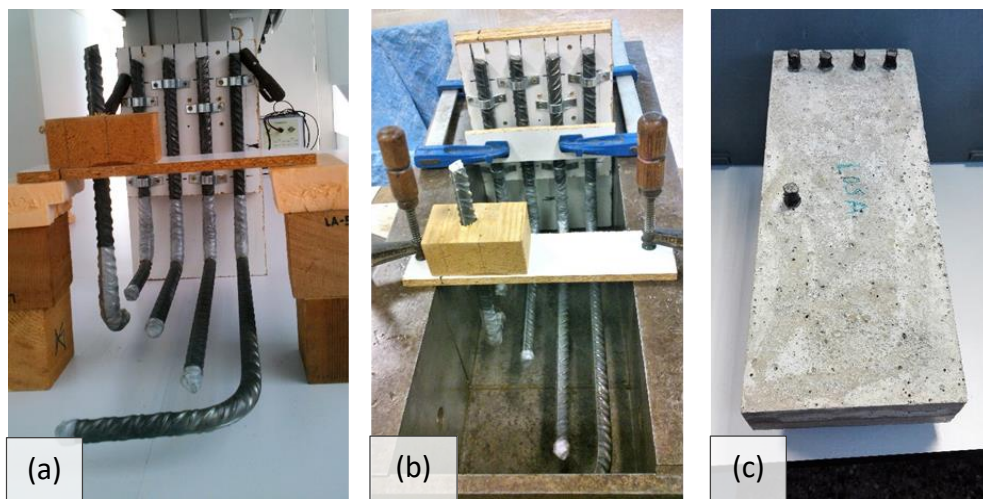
Ensamblado de las barras de armado de la losa (a), montaje en el molde para el hormigonado (b) y aspecto final de la losa tras el desmoldado (c).
